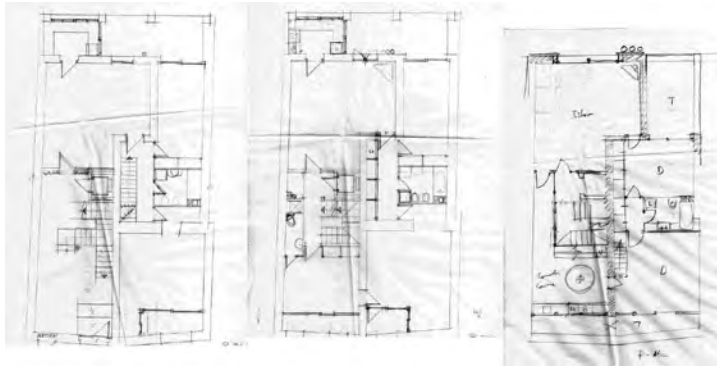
Croquis del arquitecto de la distribución interior de la planta baja, planta tipo y planta tercera, de mediados de 1978. Dibujo a lápiz sobre sulfurizado. Archivo R.M.Puig.
